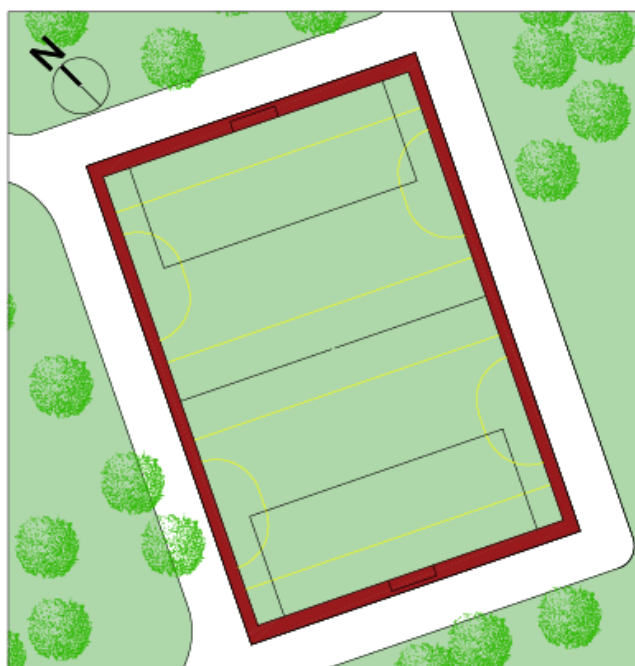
Planta Pormenor de um Polidesportivo.
